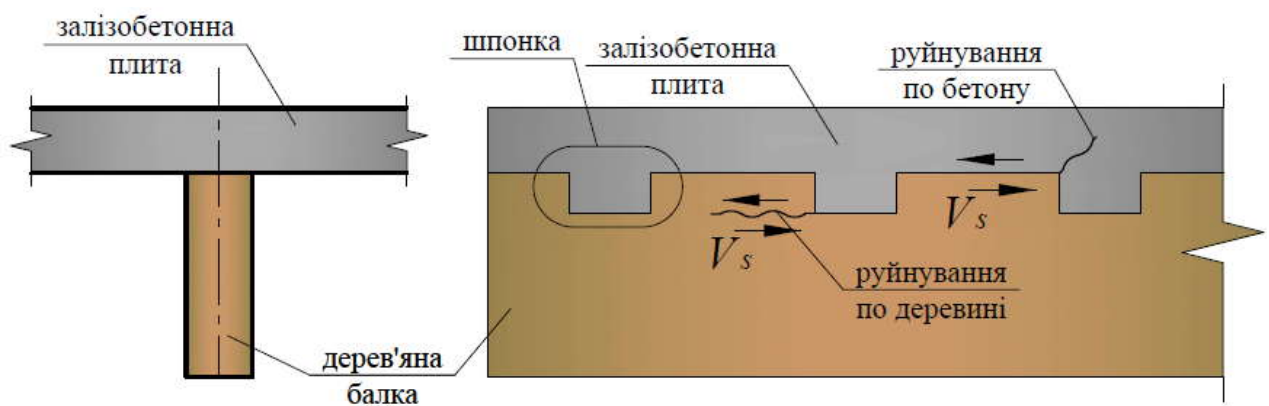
Деревозалізобетонне гібридне перекриття зі з'єднанням у вигляді неармованих бетонних шпонок
